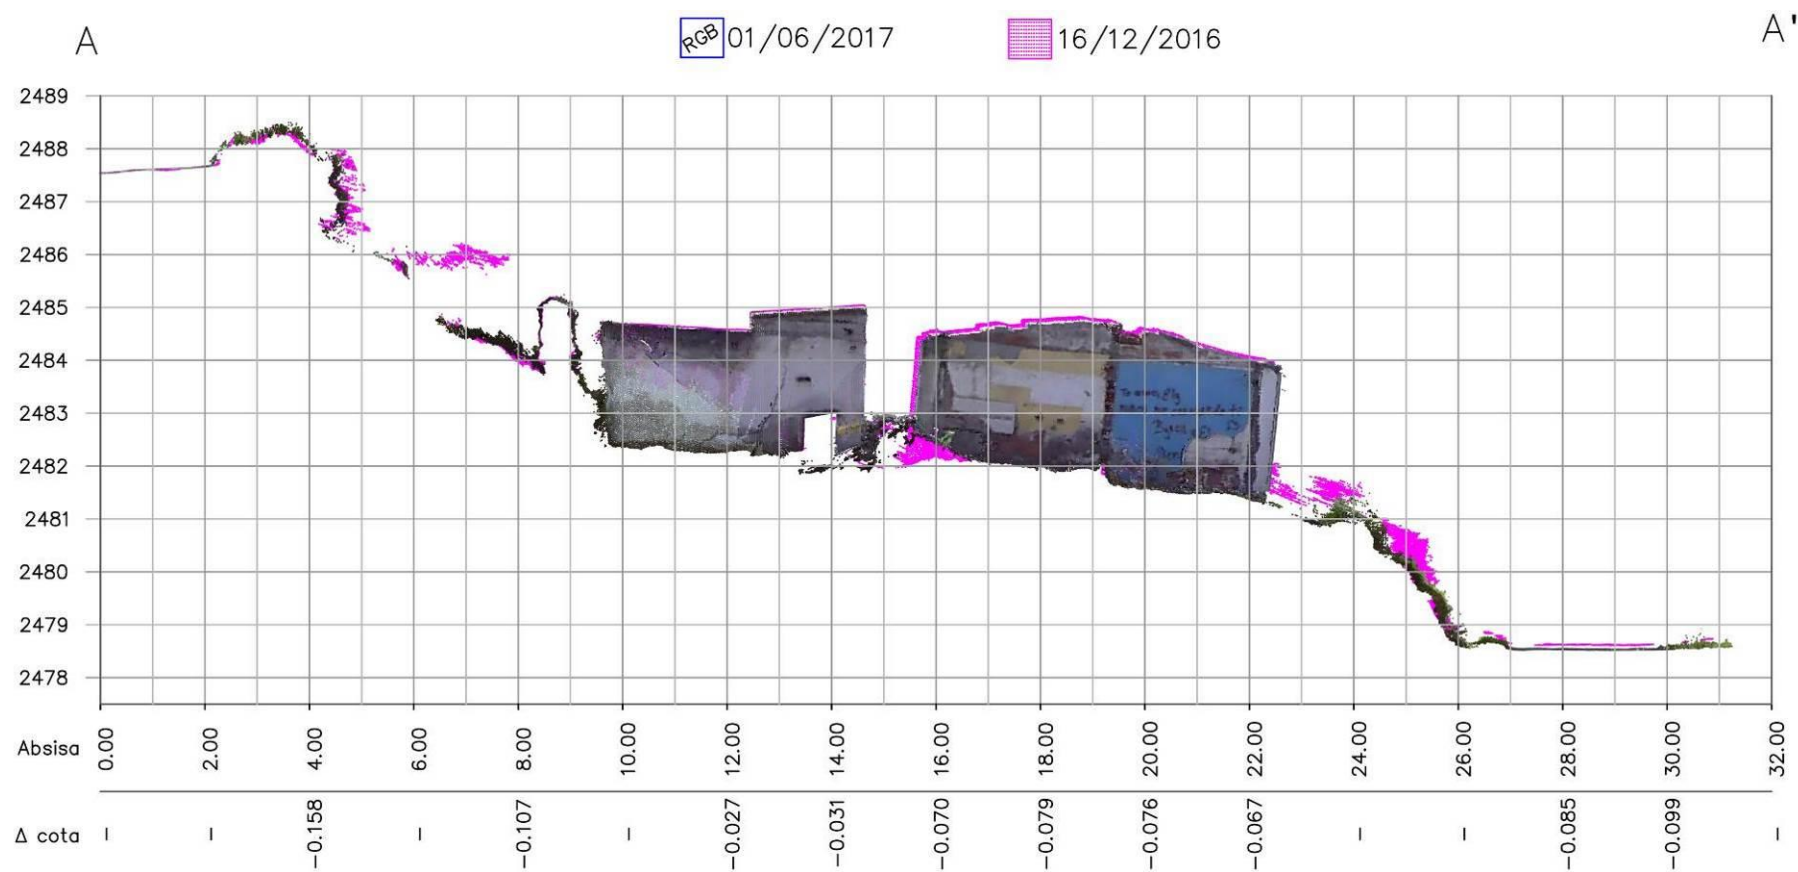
Levantamiento 1 vs levantamiento 2, perfil A-A'.
